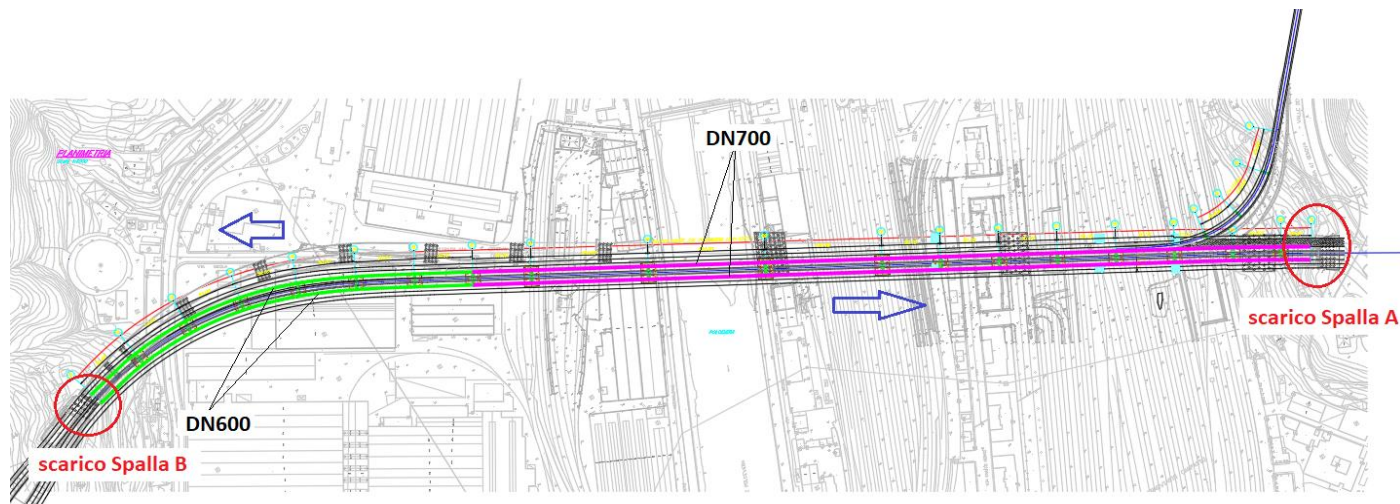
Planimetria schematica dei collettori di drenaggio.
